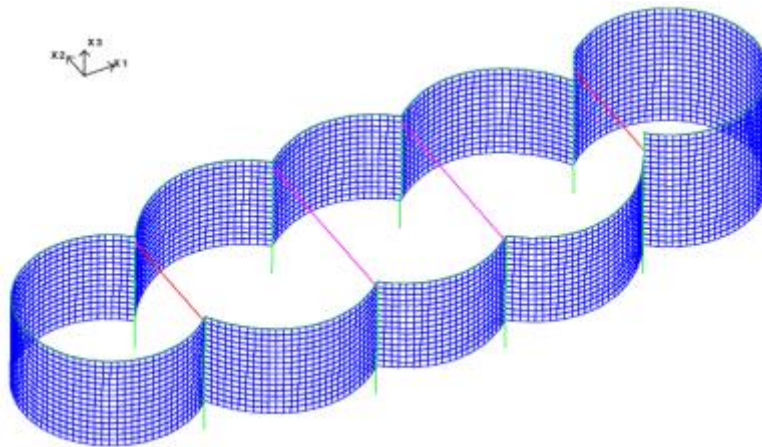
Malha de elementos finitos utilizada (adaptado CJC, 2009).
